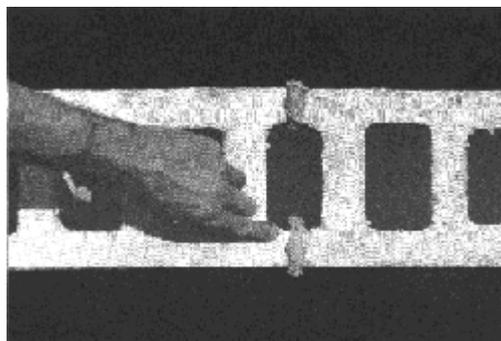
Junta vertical correcta de dos bloques de hormigón.
